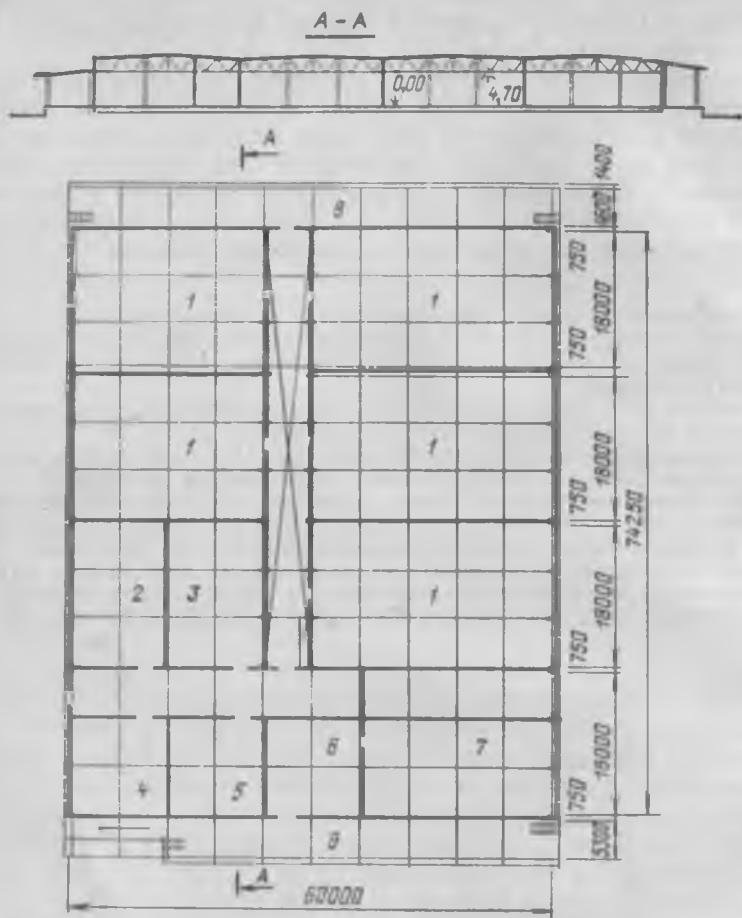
Схема плана сырохранилища на 1000 т единовременного хранения (легкие металлические конструкции):
